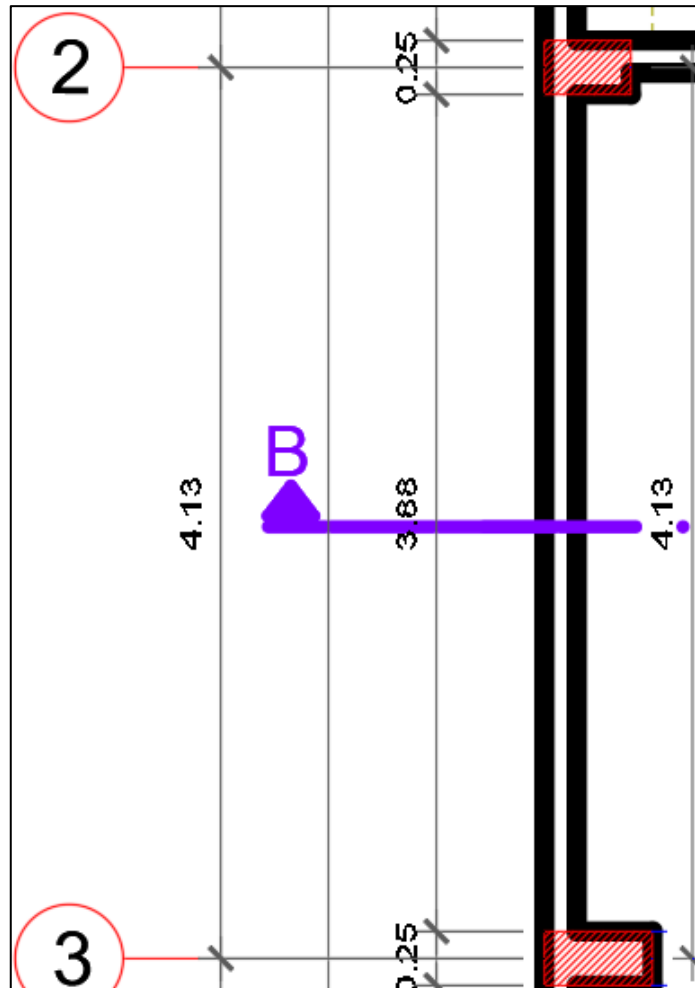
Detalle de predimensionamiento de Viga Secundaria en Dirección “Y”
